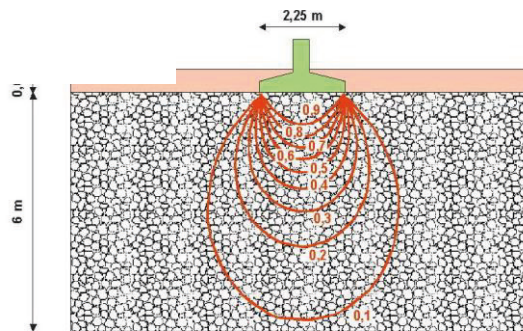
Bulbo de tensiones para una zapata aislada de ancho zapata  $B = 2.25$  m.
